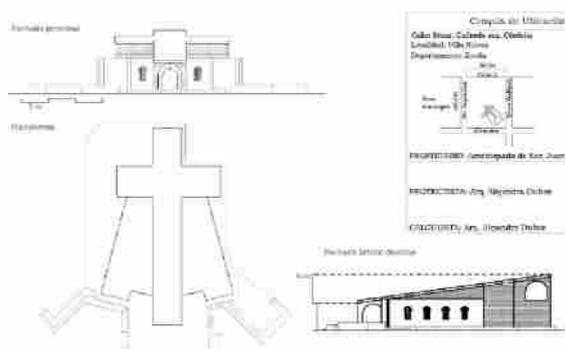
Planos - Elaborado por M. Florencia Pelanda
